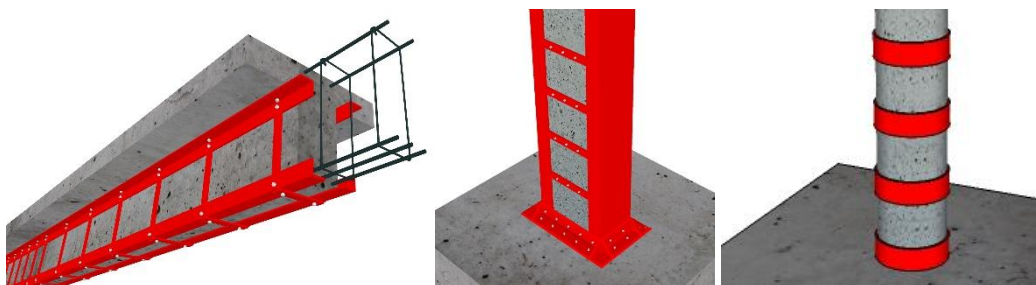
Pormenores do reforço de vigas e pilares com chapas ou perfis de aço colados com resina epoxídica [26].
